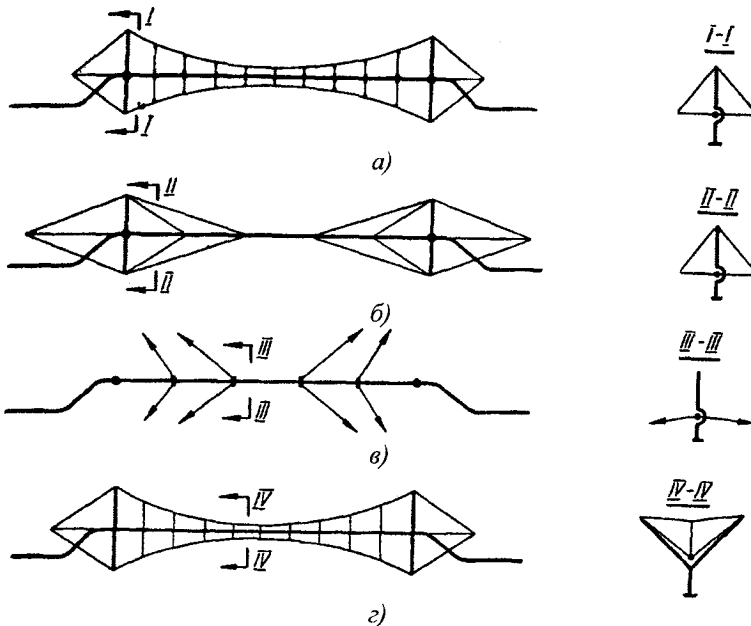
Схеми вітрових ферм і пристроїв для сприйняття вітрового навантаження: а – горизонтальні вітрові ферми; б – горизонтальні радіально-вантові ферми; в – бічні відтяжки; г – висячий перехід з похилими фермами і V-подібними пілонами
